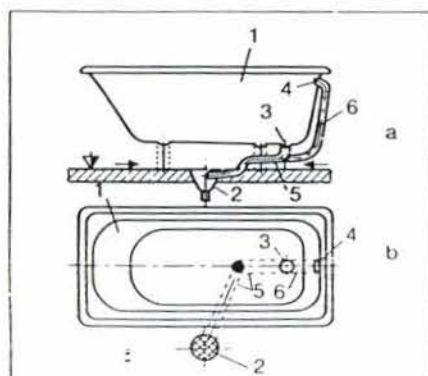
Legarea la canalizare a căzii de baie cu fund plan:
